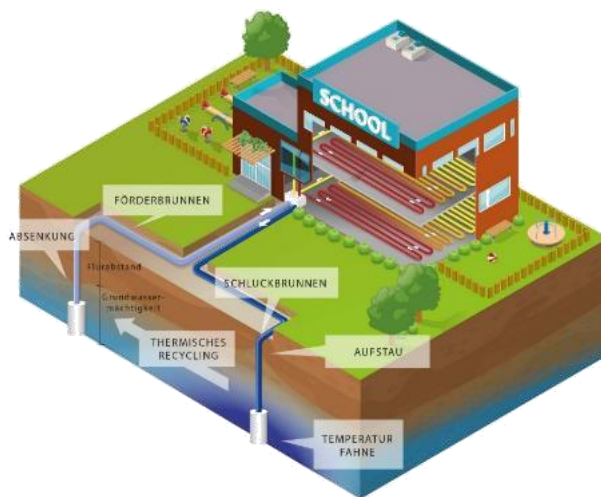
Der typische Aufbau einer Grundwasserwärmepumpe mit Förder- und Schluckbrunnen
